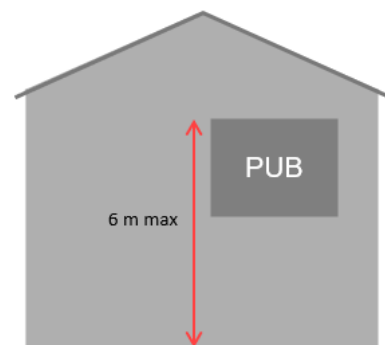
Schéma explicatif de la règle de hauteur pour les dispositifs muraux (schéma indicatif et non opposable)
